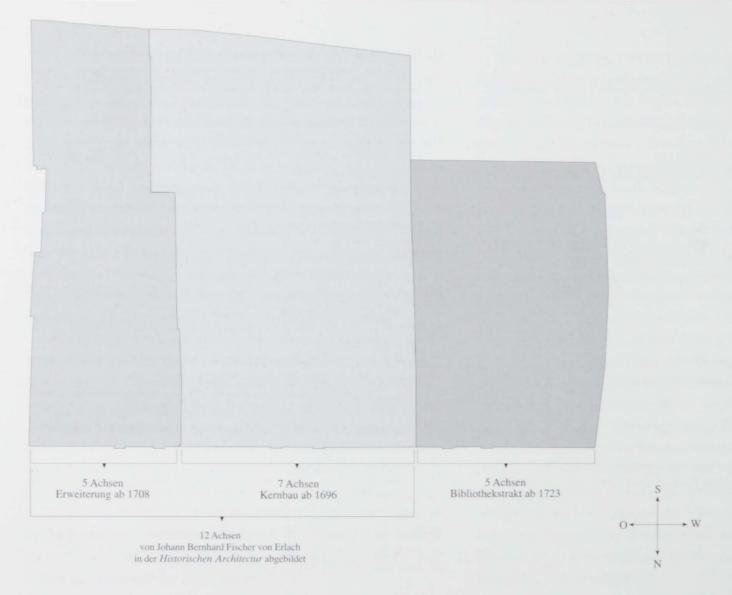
Stadtpalais des Prinzen Eugen, Erdgeschoßgrundriß mit Bauphasen
